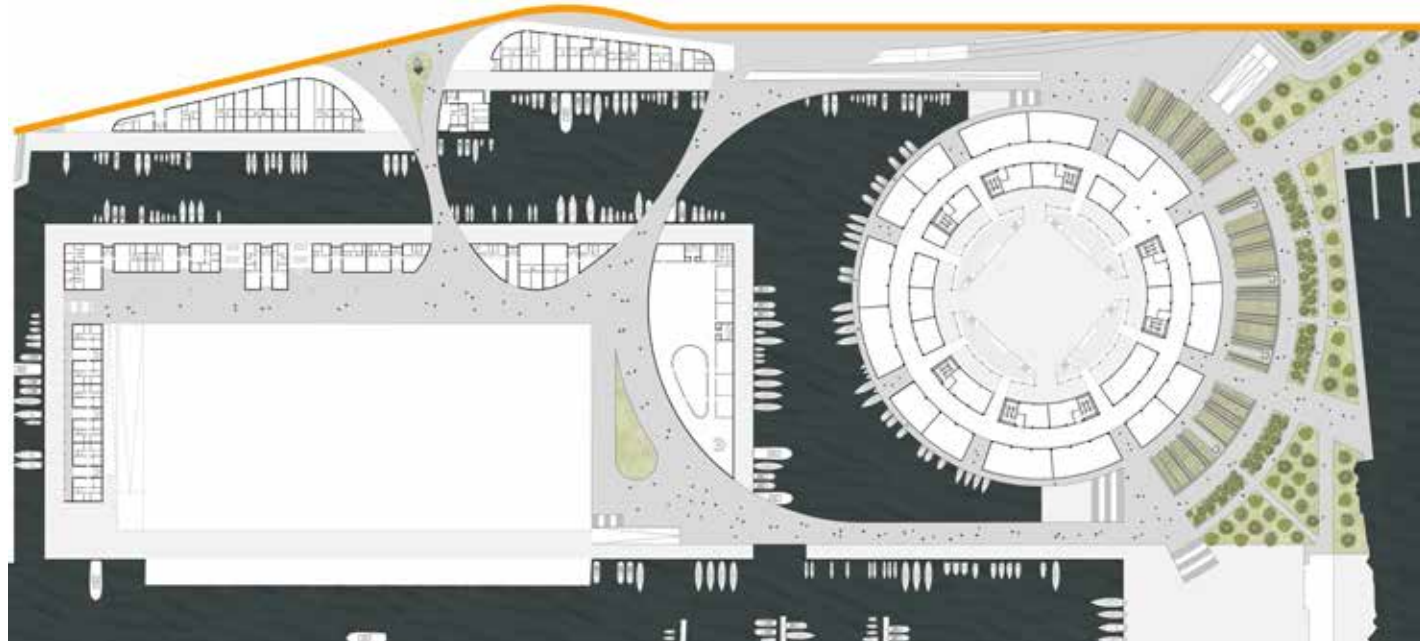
Planimetria di progetto a quota +5 metri sul livello del mare
